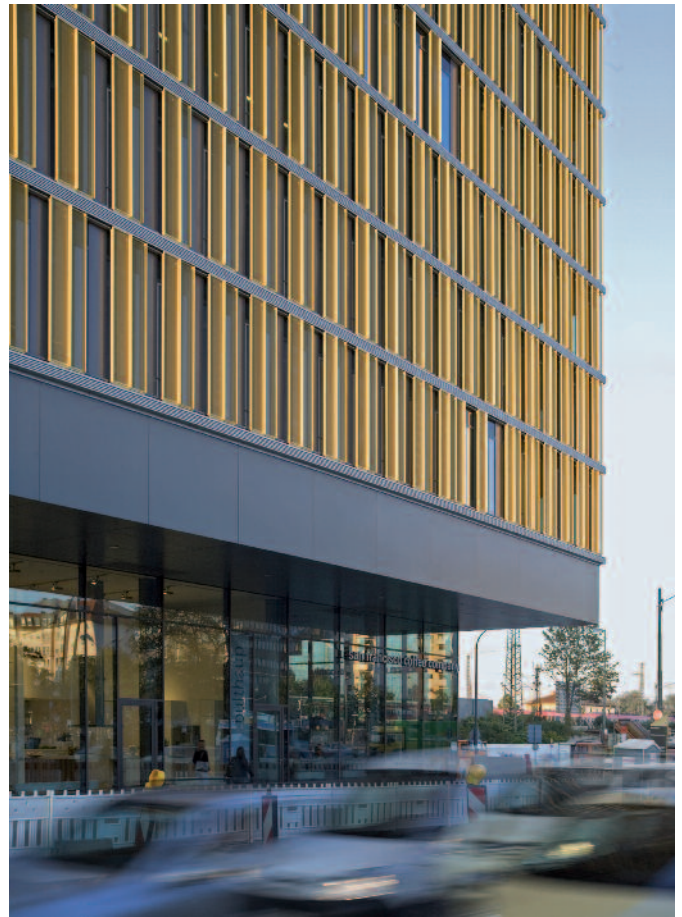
Laimer Würfel in München: Die Qualität der Fassade spielt eine entscheidende Rolle. (Architekt: FRICK KRÜGER NUSSER PLAN2, München)
